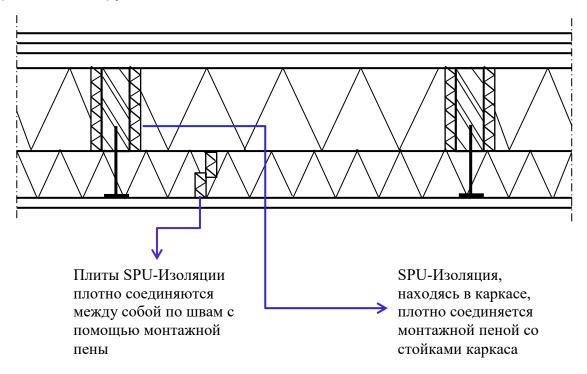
Схема нанесения монтажной пены в каркасных зданиях
